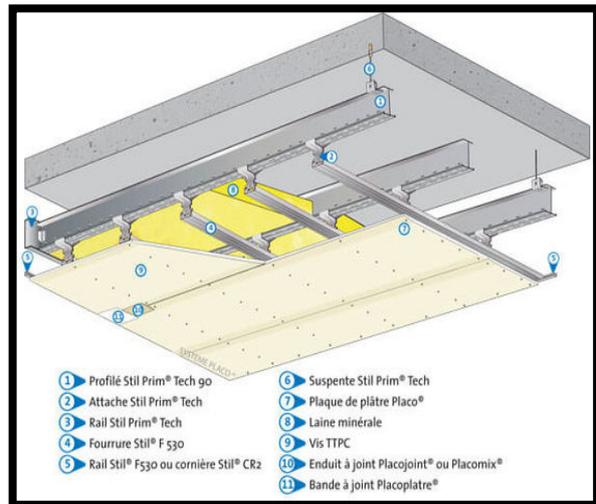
détails d'un faux plafond (source : système steme stil prim tech pour plafond long eu porté).
